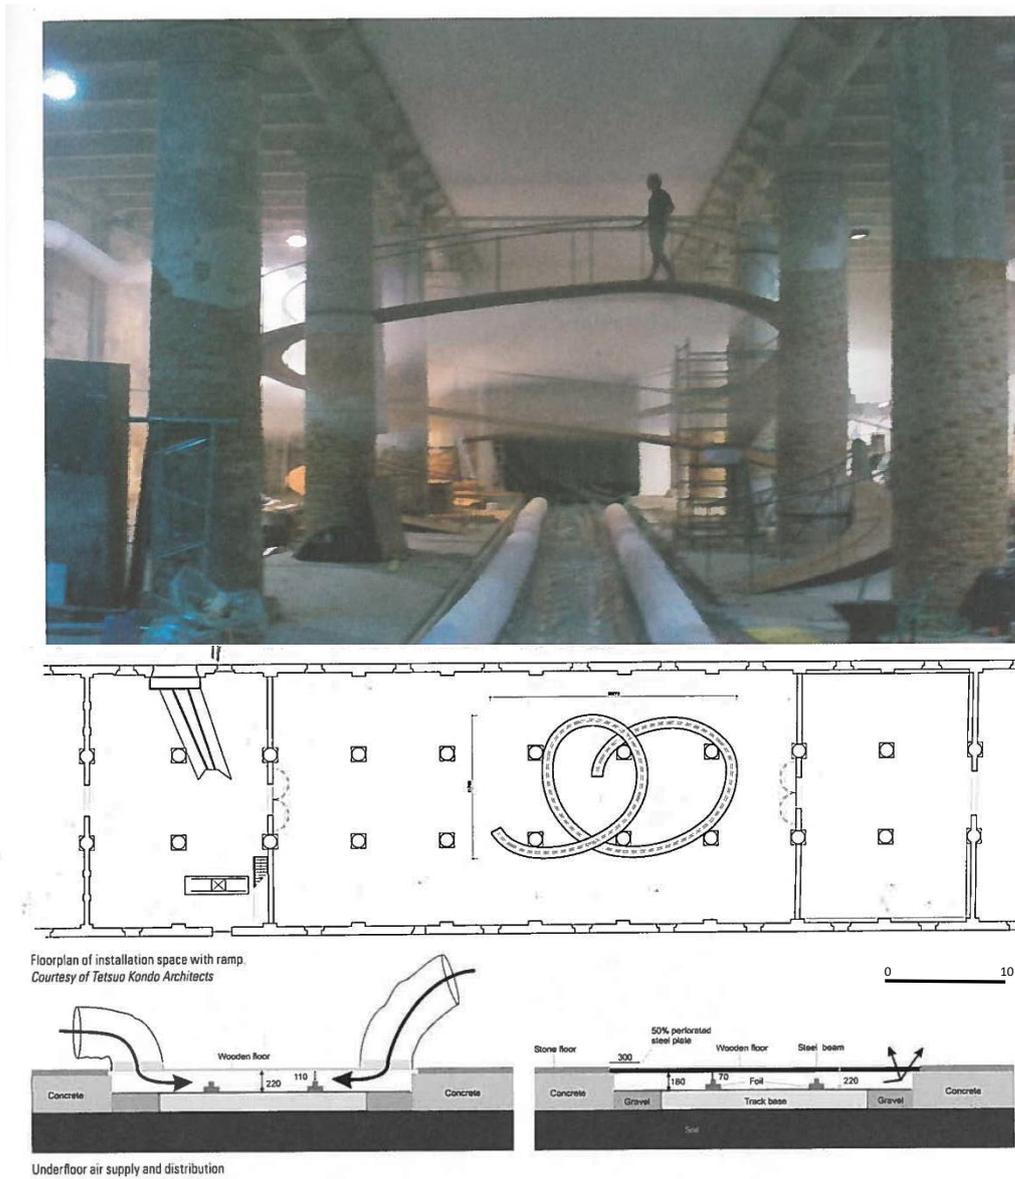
Planta Geral da Instalação e processo de instalação do sistema de ventilação.
